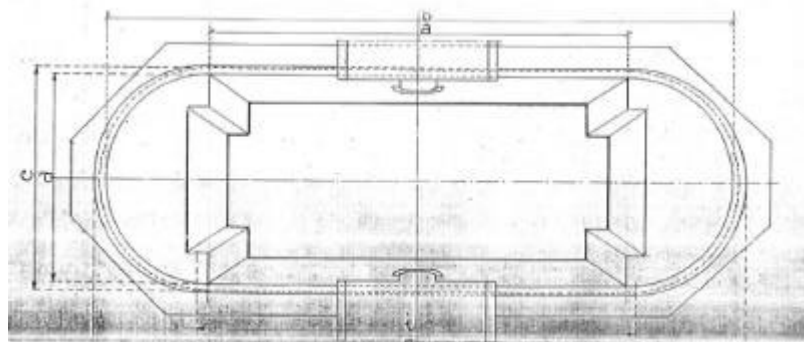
sezione di una *pila-spalla* del viadotto Ellero - linea Fossano-Mondovì, progr. 19+722 (Archivio FS - TO).
